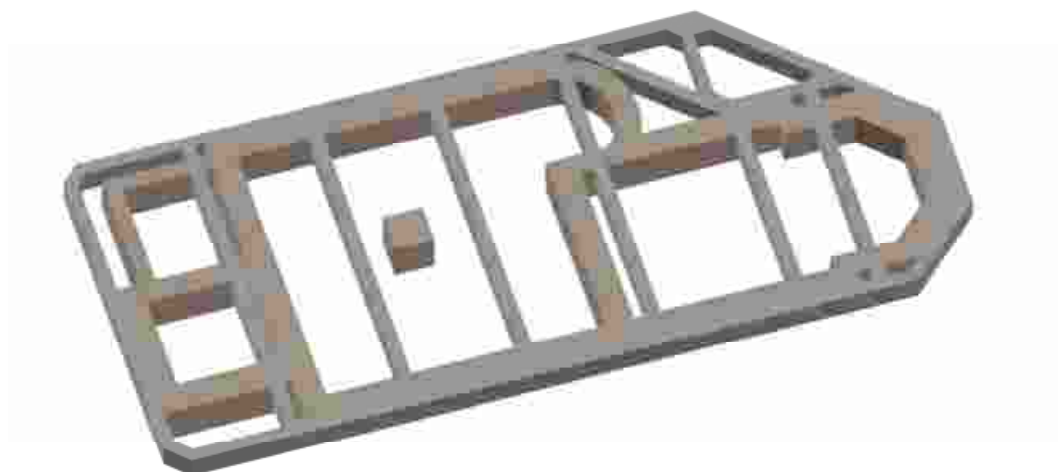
Модель бутового фундамента и пояса усиления
